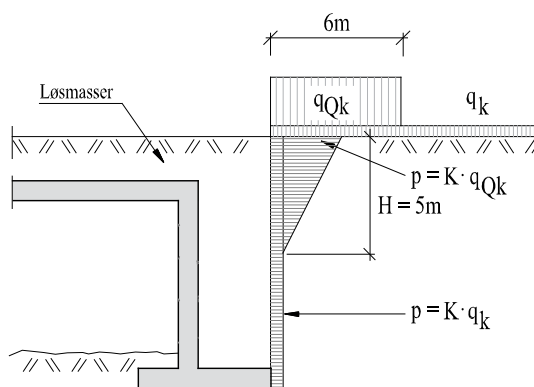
Trafikklast på vegfylling og tilhørende jordtrykk, snitt A - A
